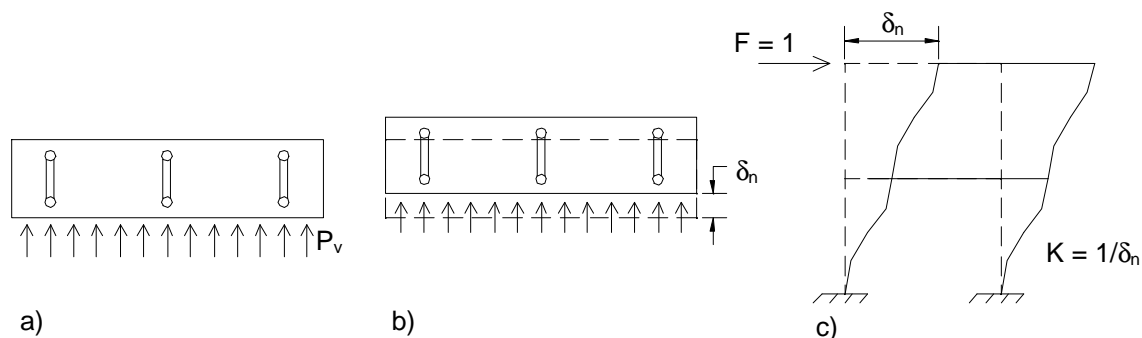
Vista em planta da atuação de esforços transversais no tabuleiro (a); translação horizontal do tabuleiro (b); determinação da rigidez transversal do pórtico (c).
